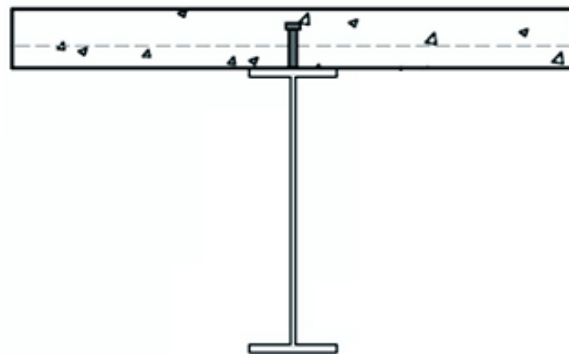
Detalhe de pino Stud executando a ligação entre a laje de concreto e a viga de aço.
